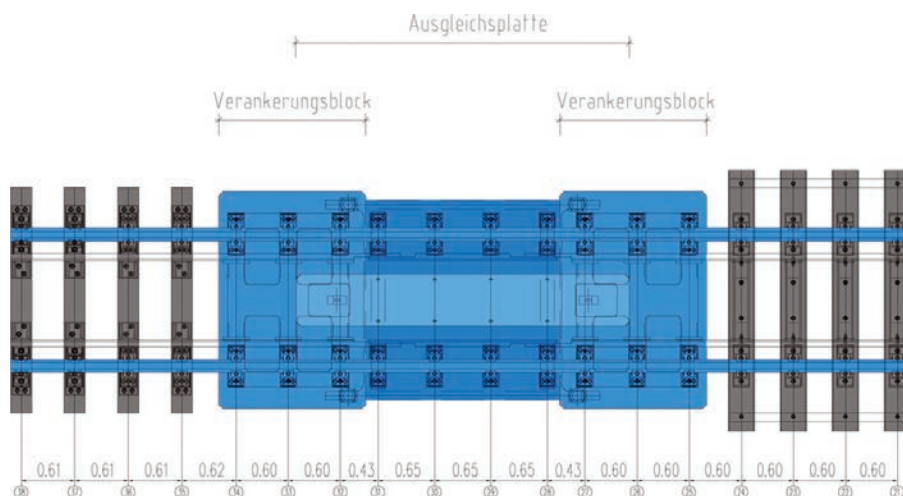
Detailgrundriss mit Ausgleichsplatte und Verankerungsblöcken
